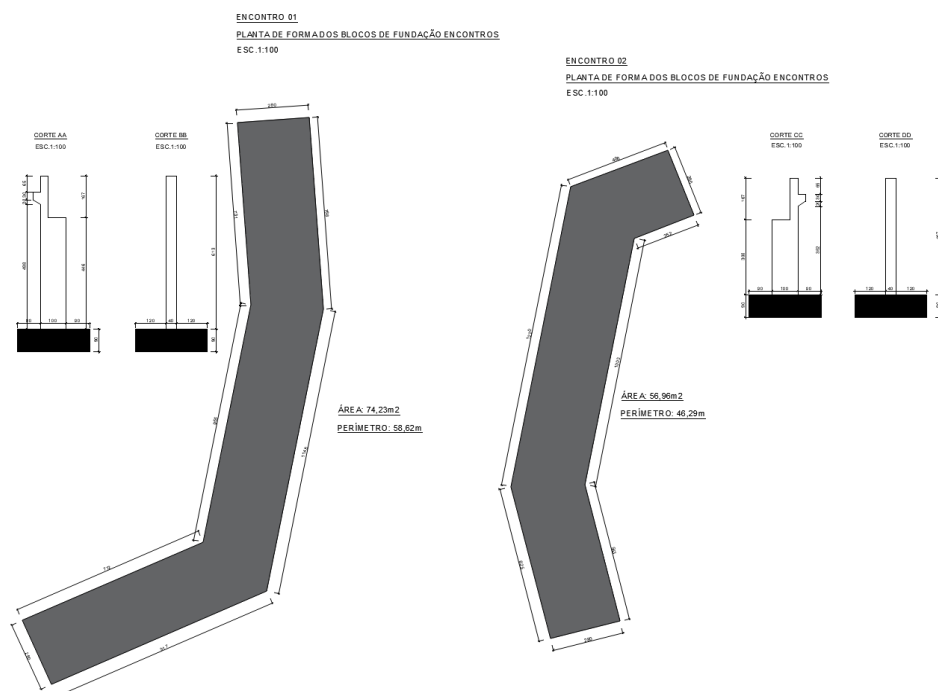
Vista Planta dos encontros 01 e 02 do Projeto Básico da Ponte localizada no futuro Contorno de Santa Maria de Jetibá / ES.
